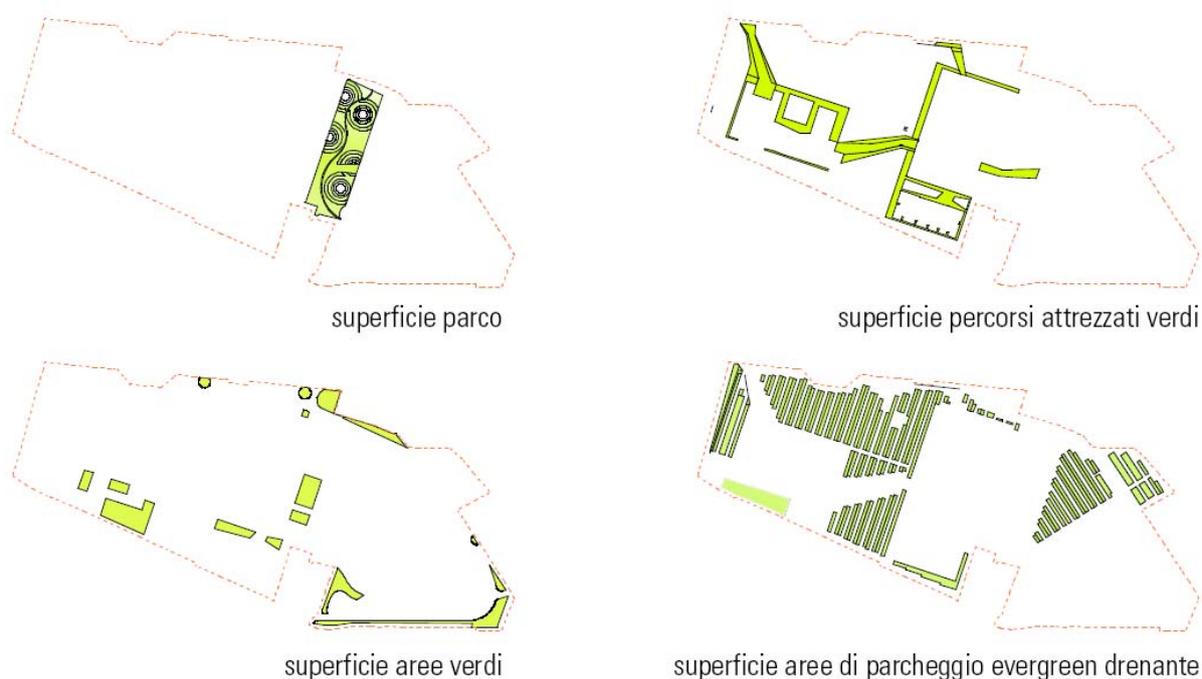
Sistemazione del verde (Stralcio elaborato 5.20 Contratto d'area Torrese-Stabiese)
